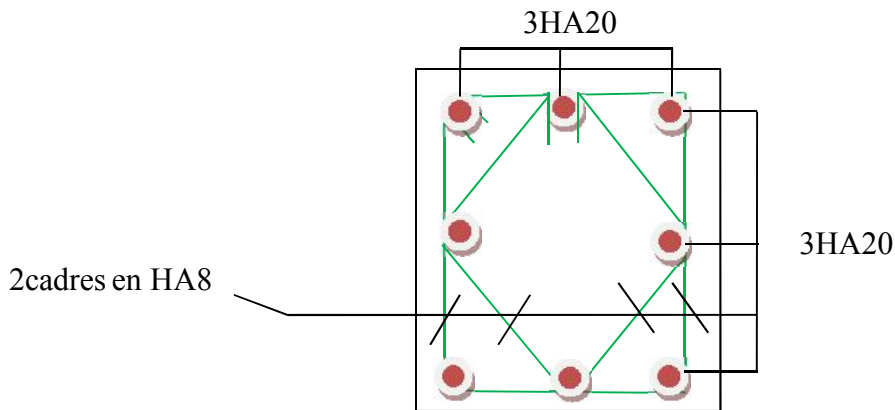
Coupe verticale sur poteau (55x55)cm²
